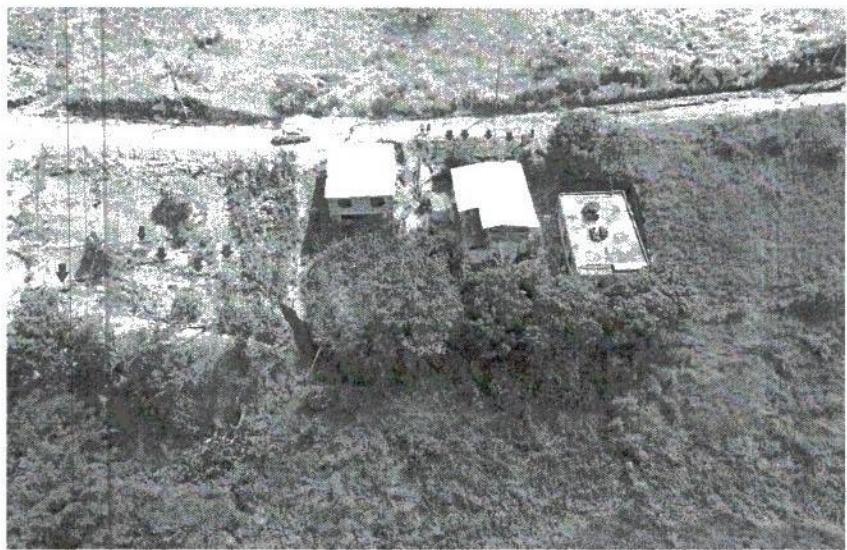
Vista da área avaliada com indicação das trincas observadas ao longo do terreno
